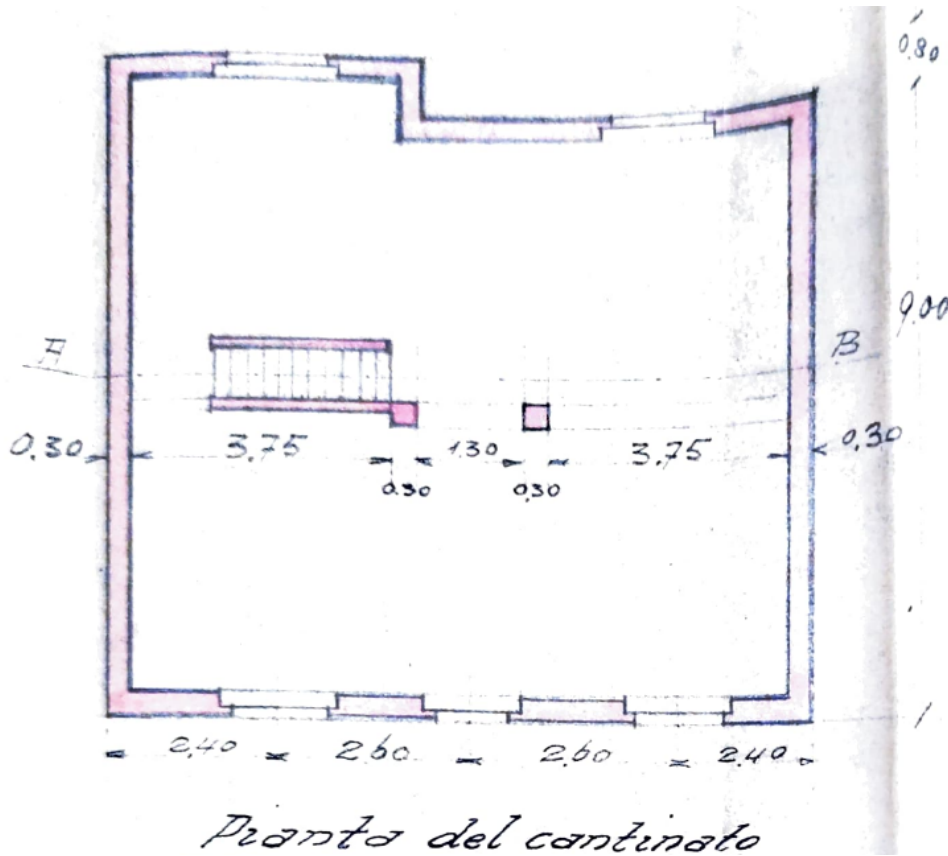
Estratto della pratica edilizia del 1950. Pianta piano interrato adibito a cantina
